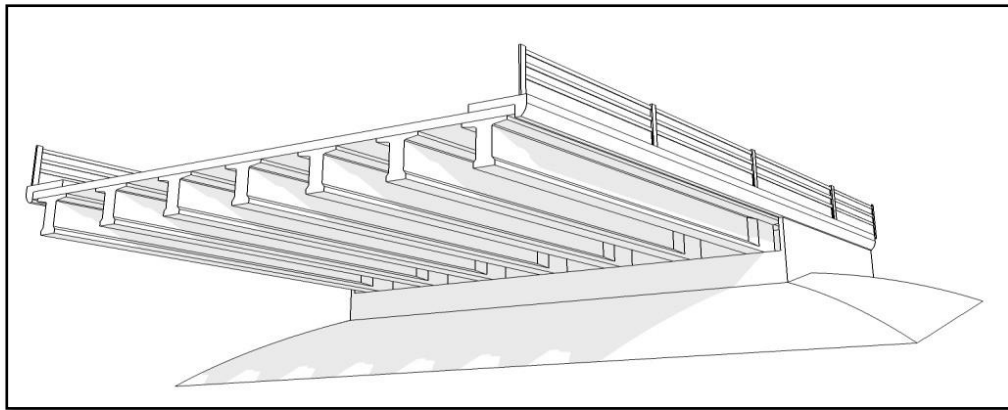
Morphologie générale d'un pont à poutres en béton précontraint.
